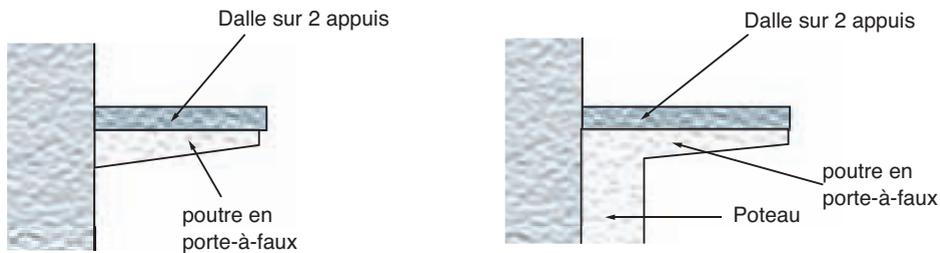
Balcons portés par des poutres en porte-à-faux
